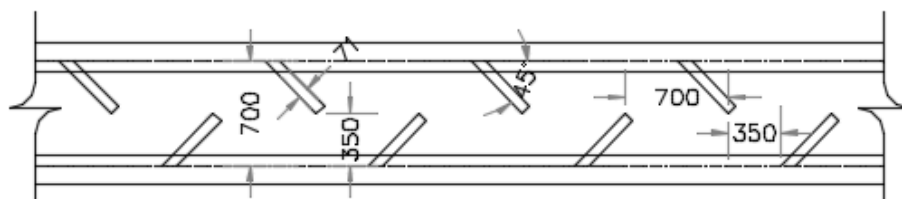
Canal de pantallas deflectoras. Vista en planta
